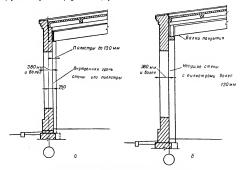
10. Привязка продольных несущих стен: с — без пиляето или с пиляетрами до 130 мм; б — с пиляетрами более 130 мм.
